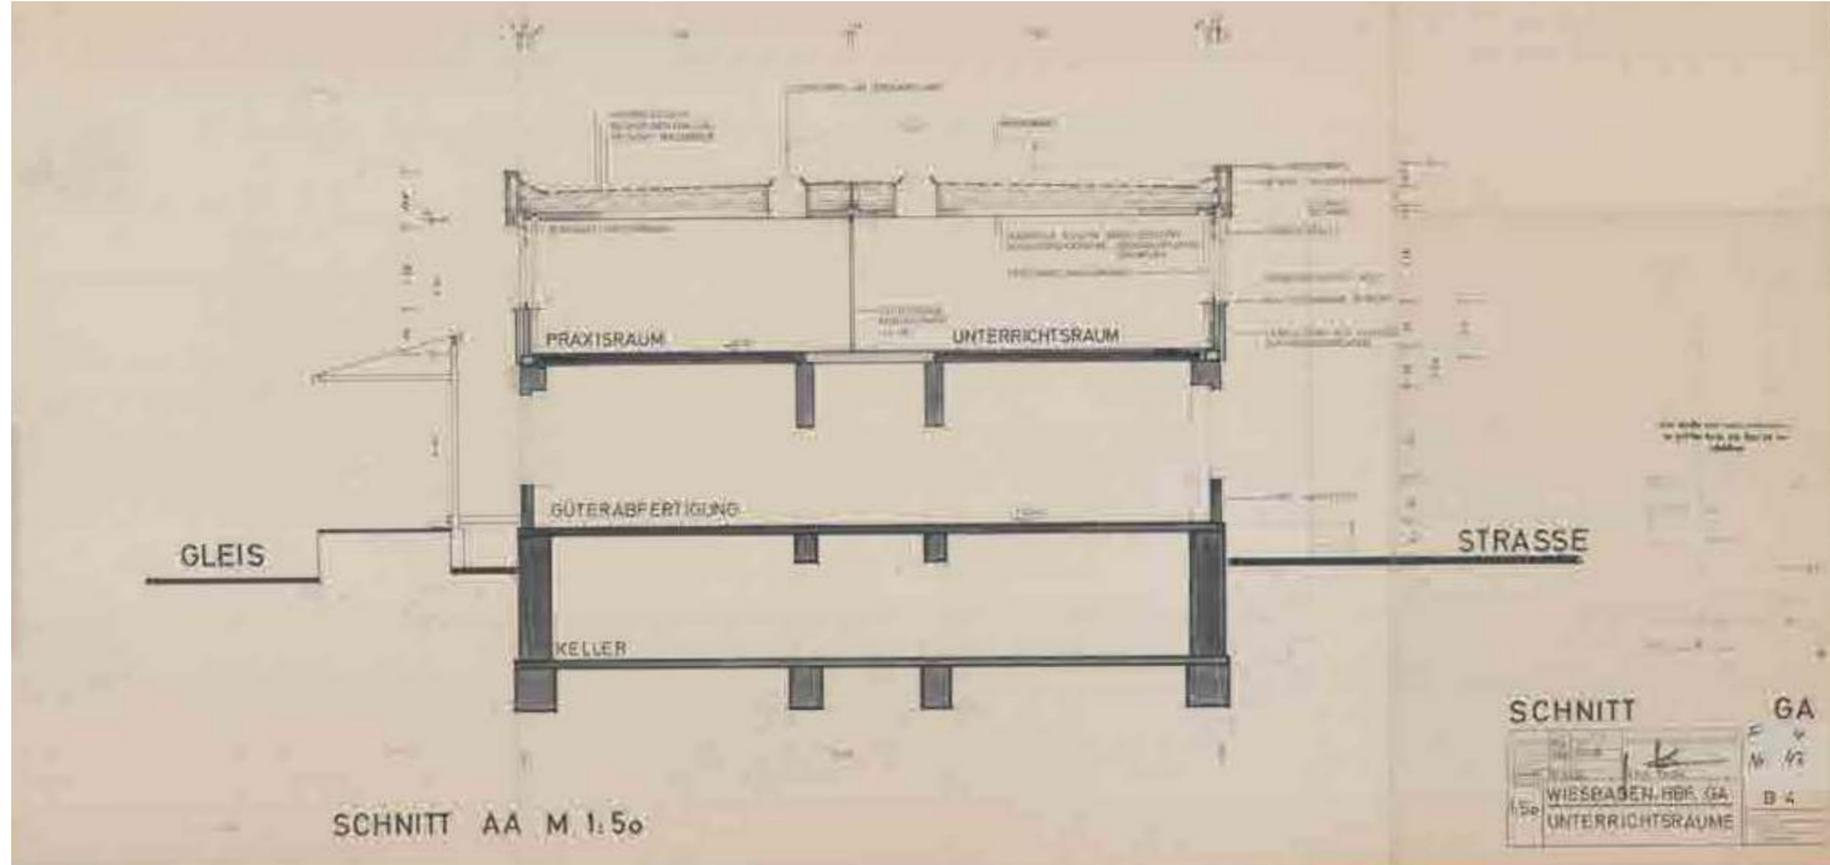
Güterabfertigung: Plan mit Querschnitt des neuen Geschossausbaues, 1975
